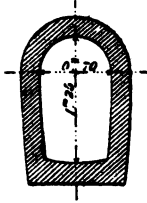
Conduite d'amenée des eaux de Portet et de Braqueville. Coupe pratiquée suivant CD de la figure 3.
